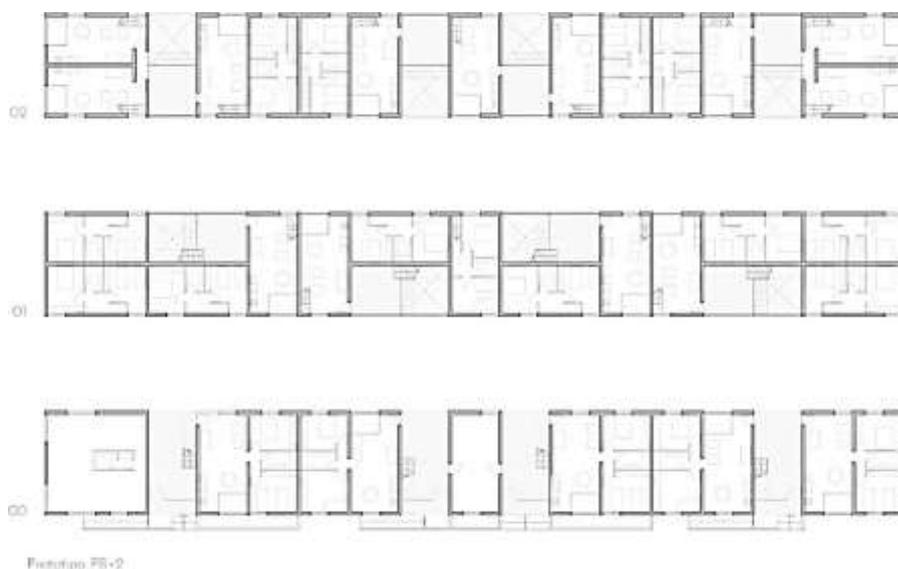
Protótipo PB+2 – A planta abaixo (00) é a planta do pavimento térreo, a 01 do primeiro pavimento e 02 do segundo pavimento. Pode-se ver as circulações entre os apartamentos.
